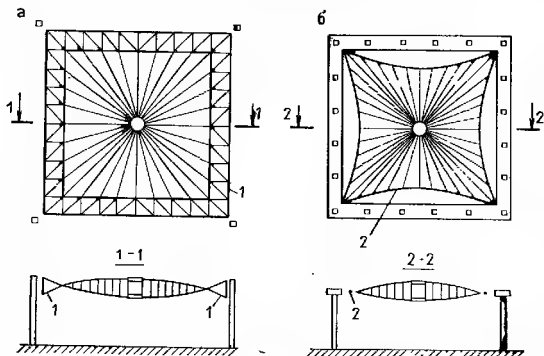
Двухслойные радиальные покрытия на квадратном плане
